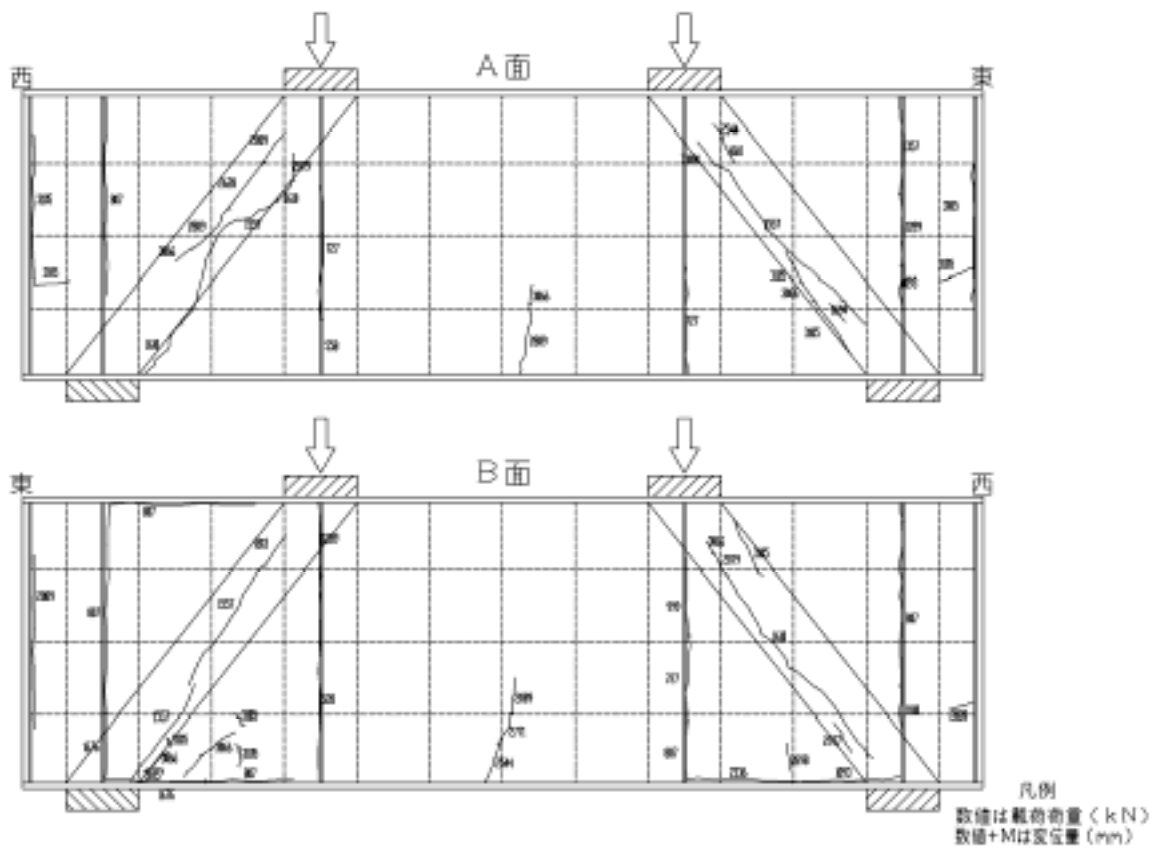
最大荷重時のひび割れ発生状況 (B-2b 試験体)
